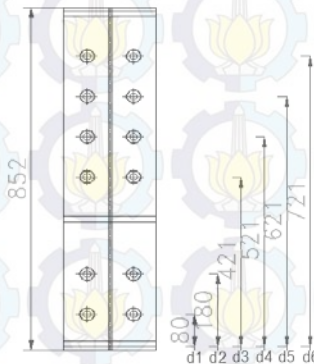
Gaya Yang Bekerja Pada Balok
